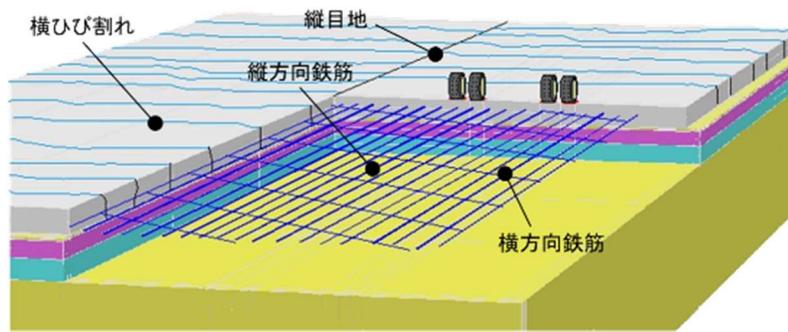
連続鉄筋コンクリート舗装 (CRCP) の構造
